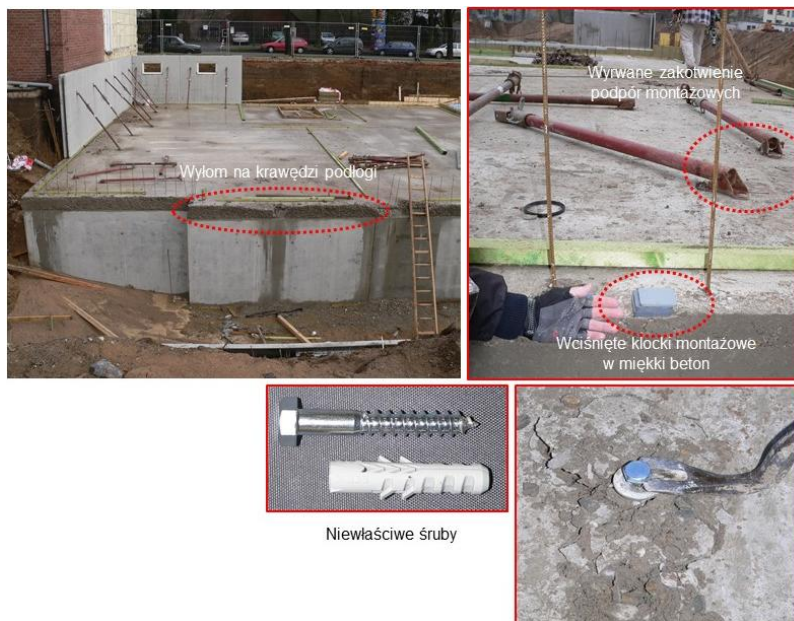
Zastany stan elementów konstrukcyjnych w porównaniu do założeń projektowych.
